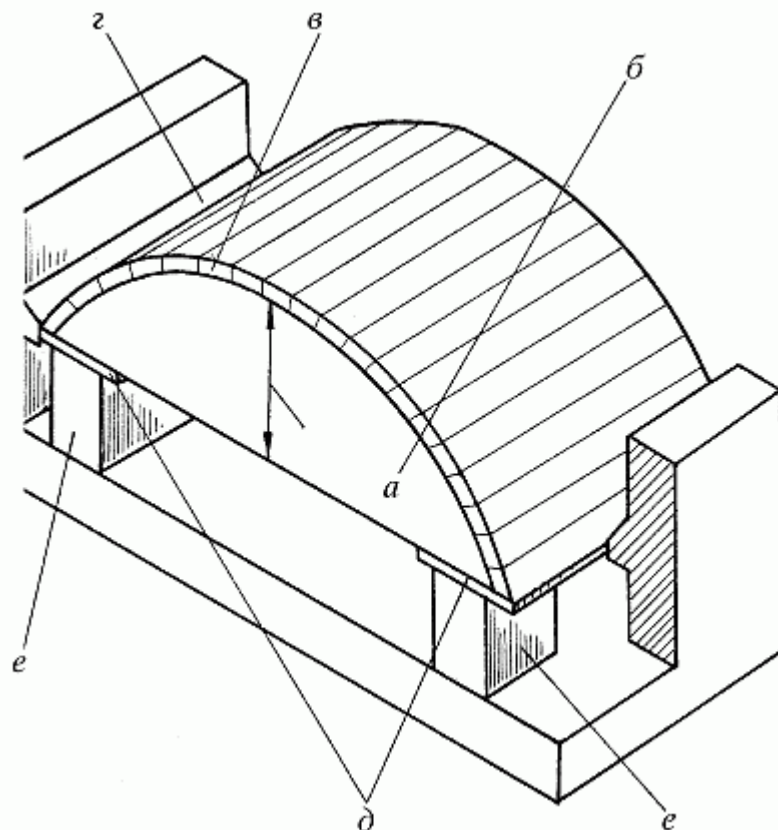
Устройство опалубки для арочного перекрытия: а – подъем свода; б – пята свода; в – опалубка; г – кружало; д – подкружальные доски; е – доски
